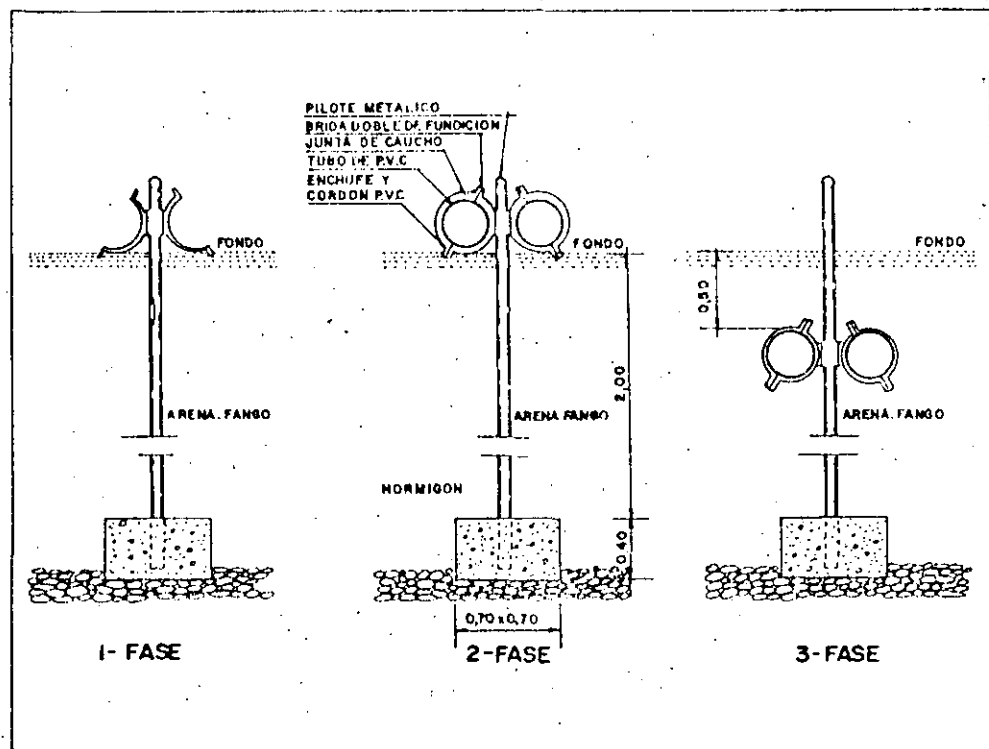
Fases de cimentación por pilote y anclaje enterrado
